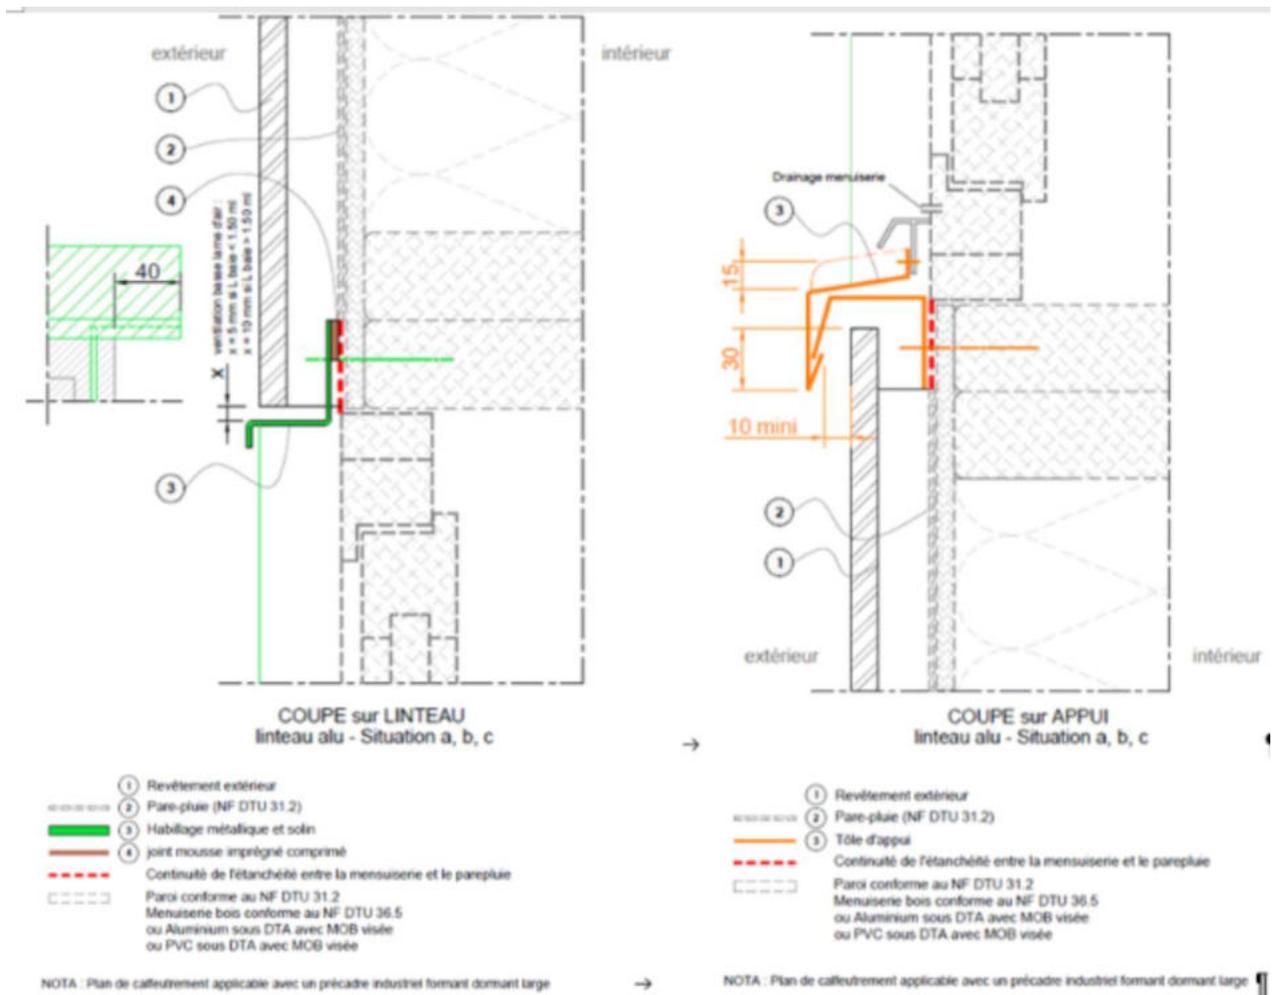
Pose sur COB - Coupe sur linteau et appui de baie - Dispositions particulières du traitement des baies (Menuiserie en tunnel extérieur)
